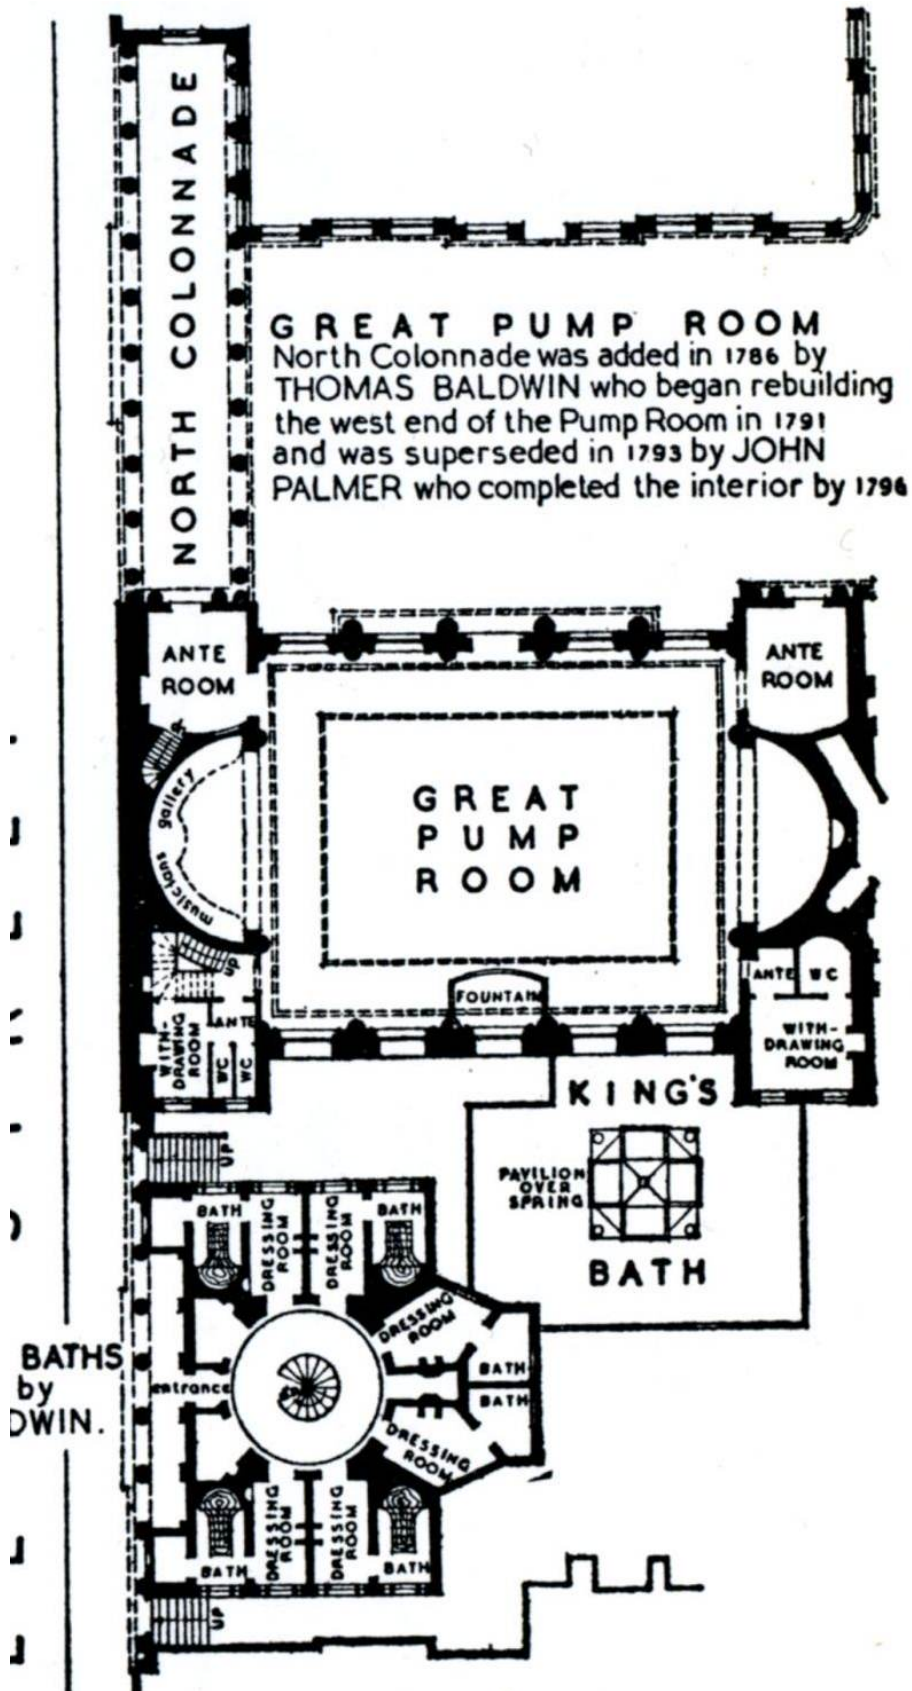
Planta Pump Room. Fuente: <https://austenonly.com/2011/01/>
